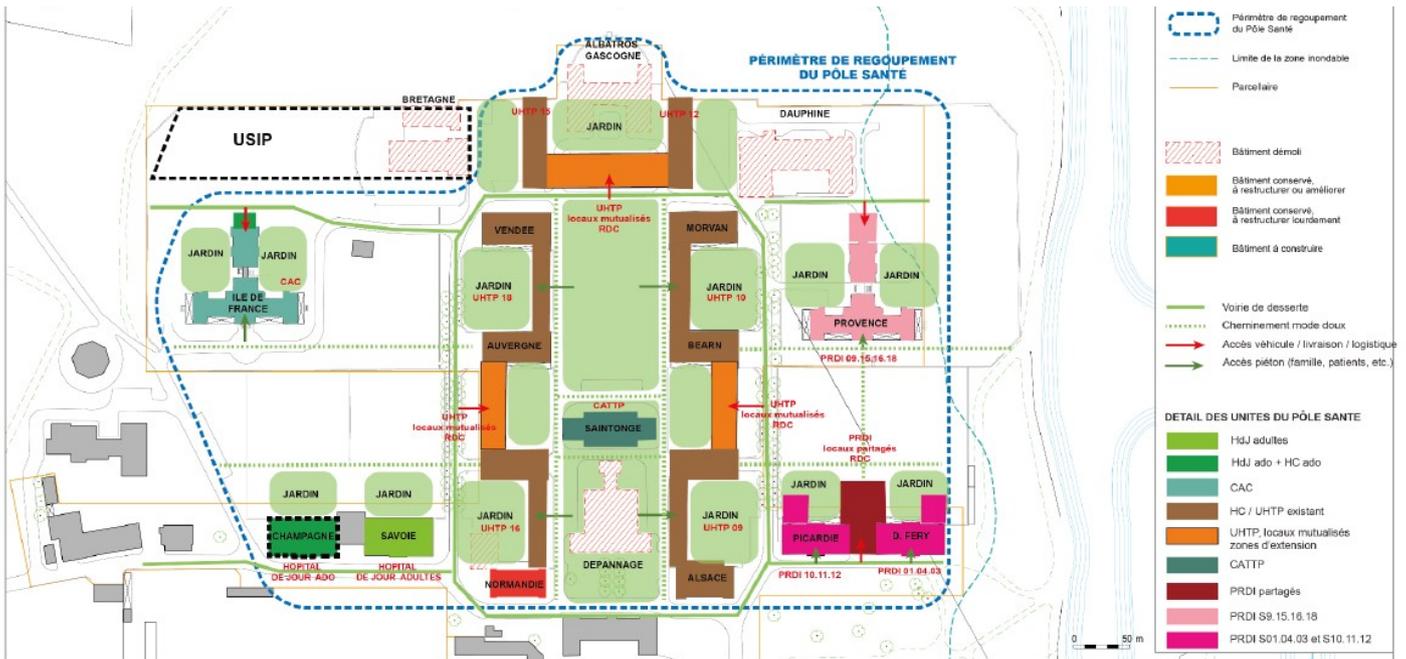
plan du projet de l'EPS - pôle « santé » (source : SDIF, p. 63)
